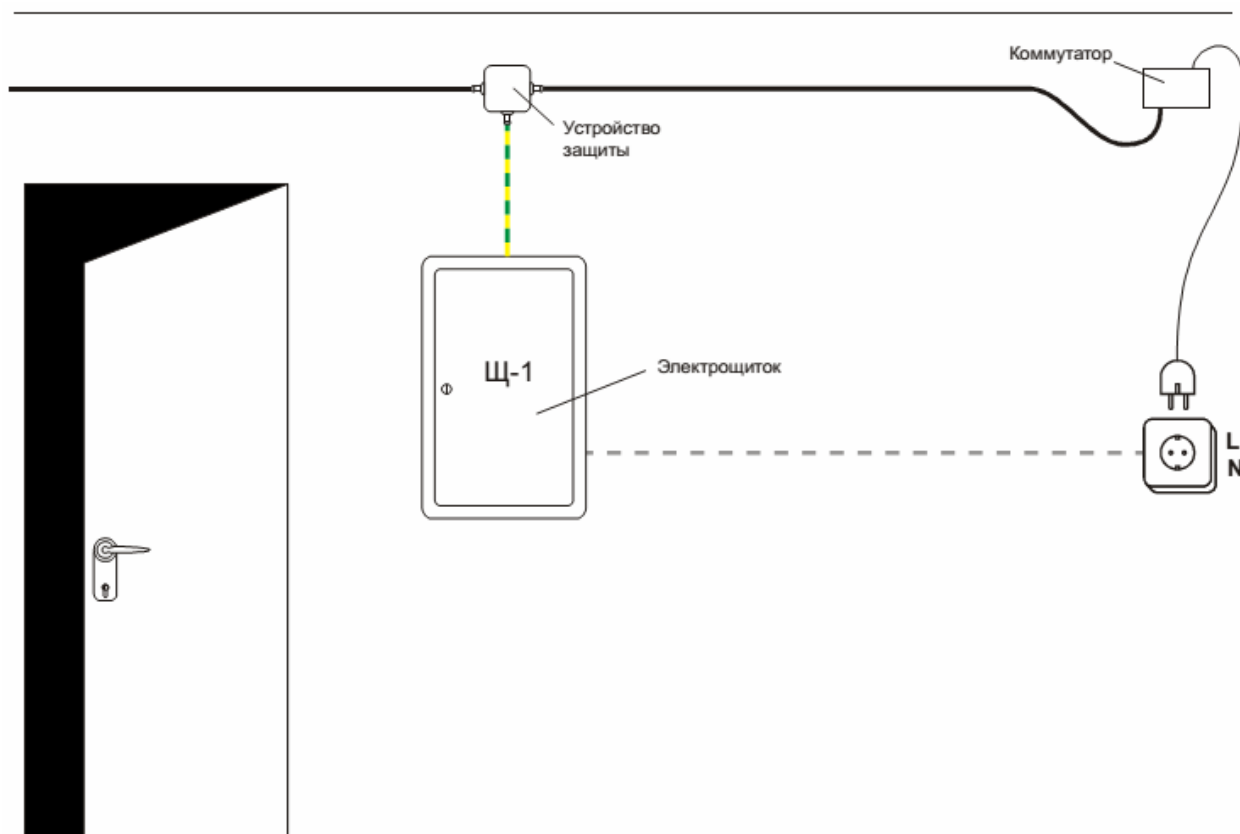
Установка оборудования в здании на стене с заземлением от электрощитка.
